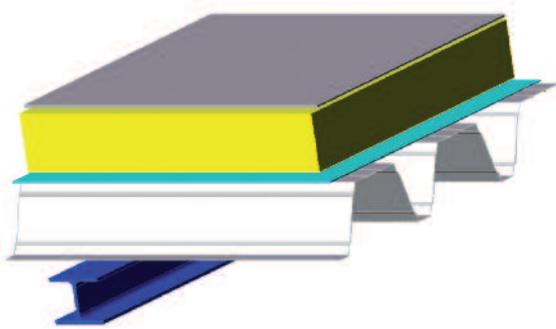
Wärmegedämmtes unbelüftetes Foliendach
